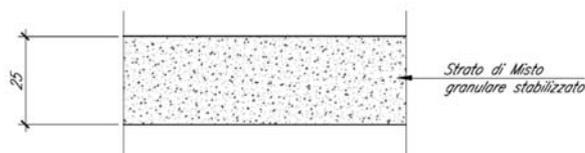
Pacchetto delle viabilità di accesso ai fondi
